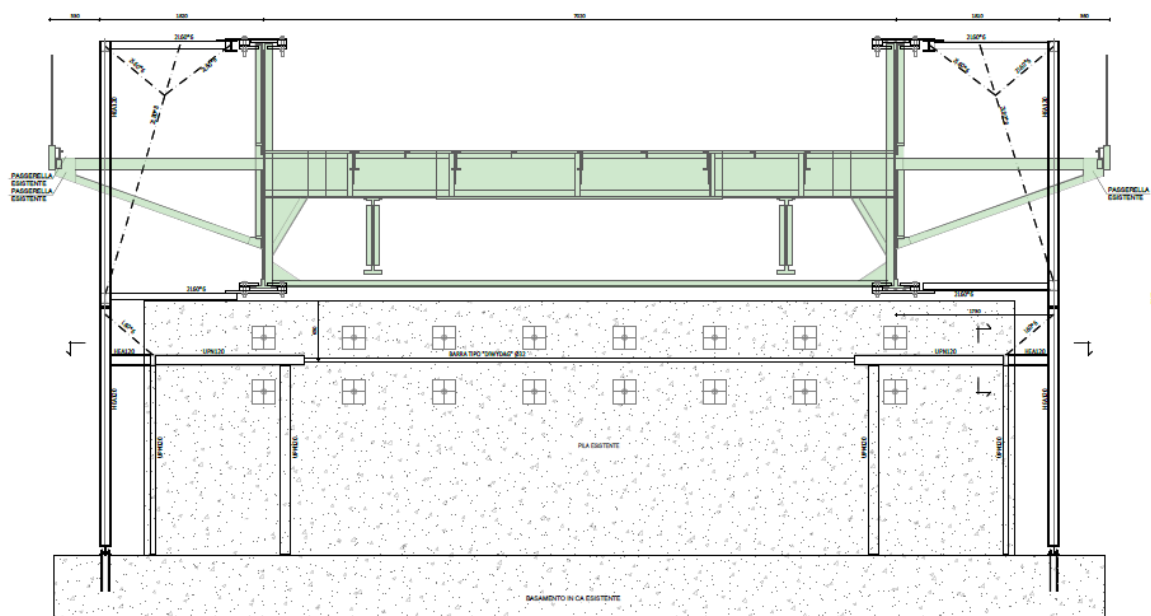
Strutture provvisionali – sezione in corrispondenza delle pile
